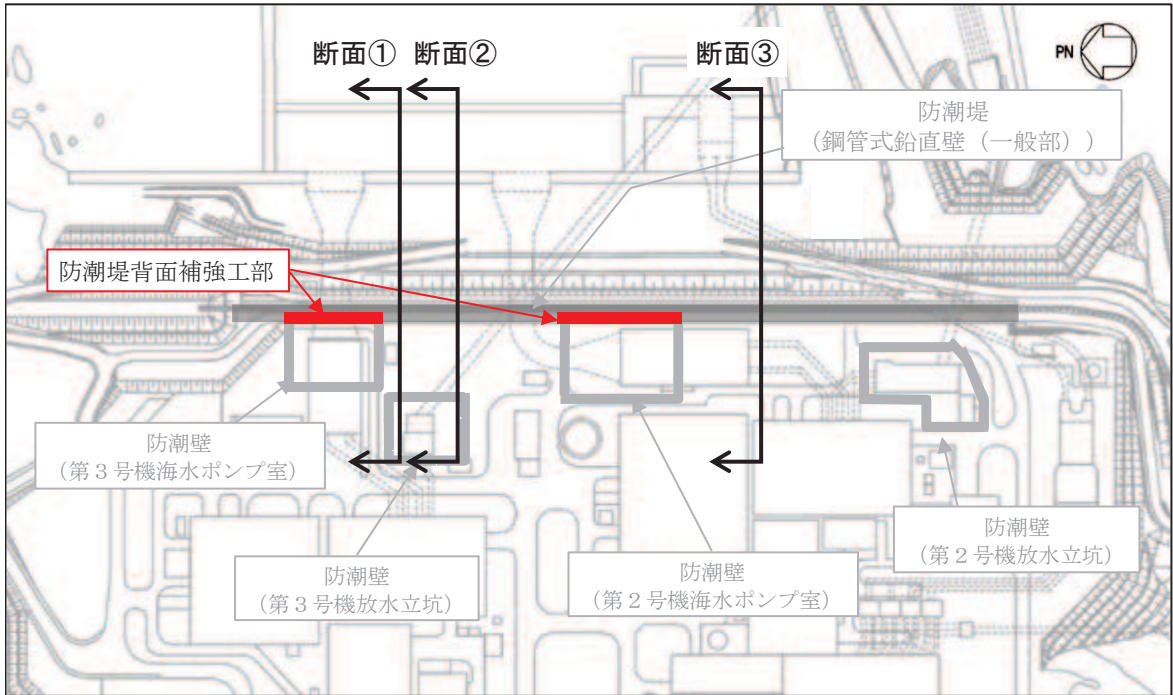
(1) 地震応答解析の実施位置 (平面図)
